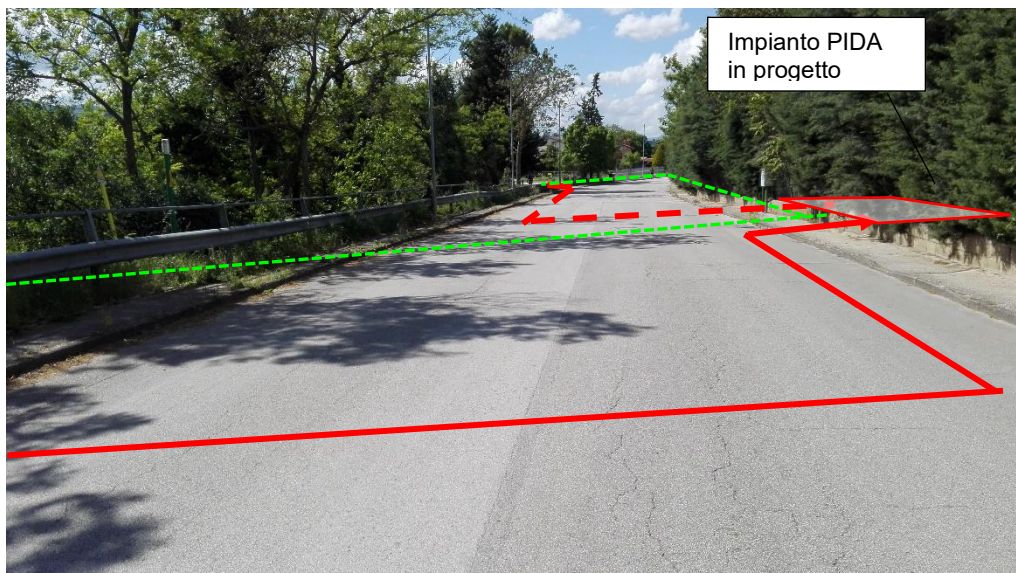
attraversamento Via Benedetto Croce e ricollegamento a impianto PIDA doppio in progetto
